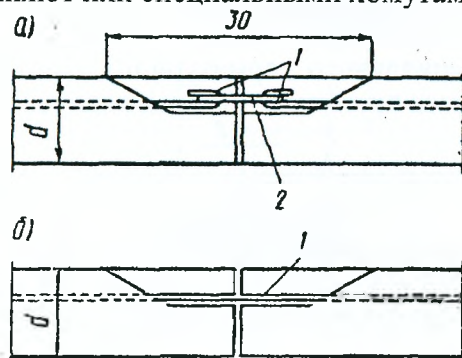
Соединения сборных железобетонных разрезных плит: а – шарнирное соединение; б – соединение сваркой; 1 – выпуск арматурных стержней; 2 – шарнирный хомут
